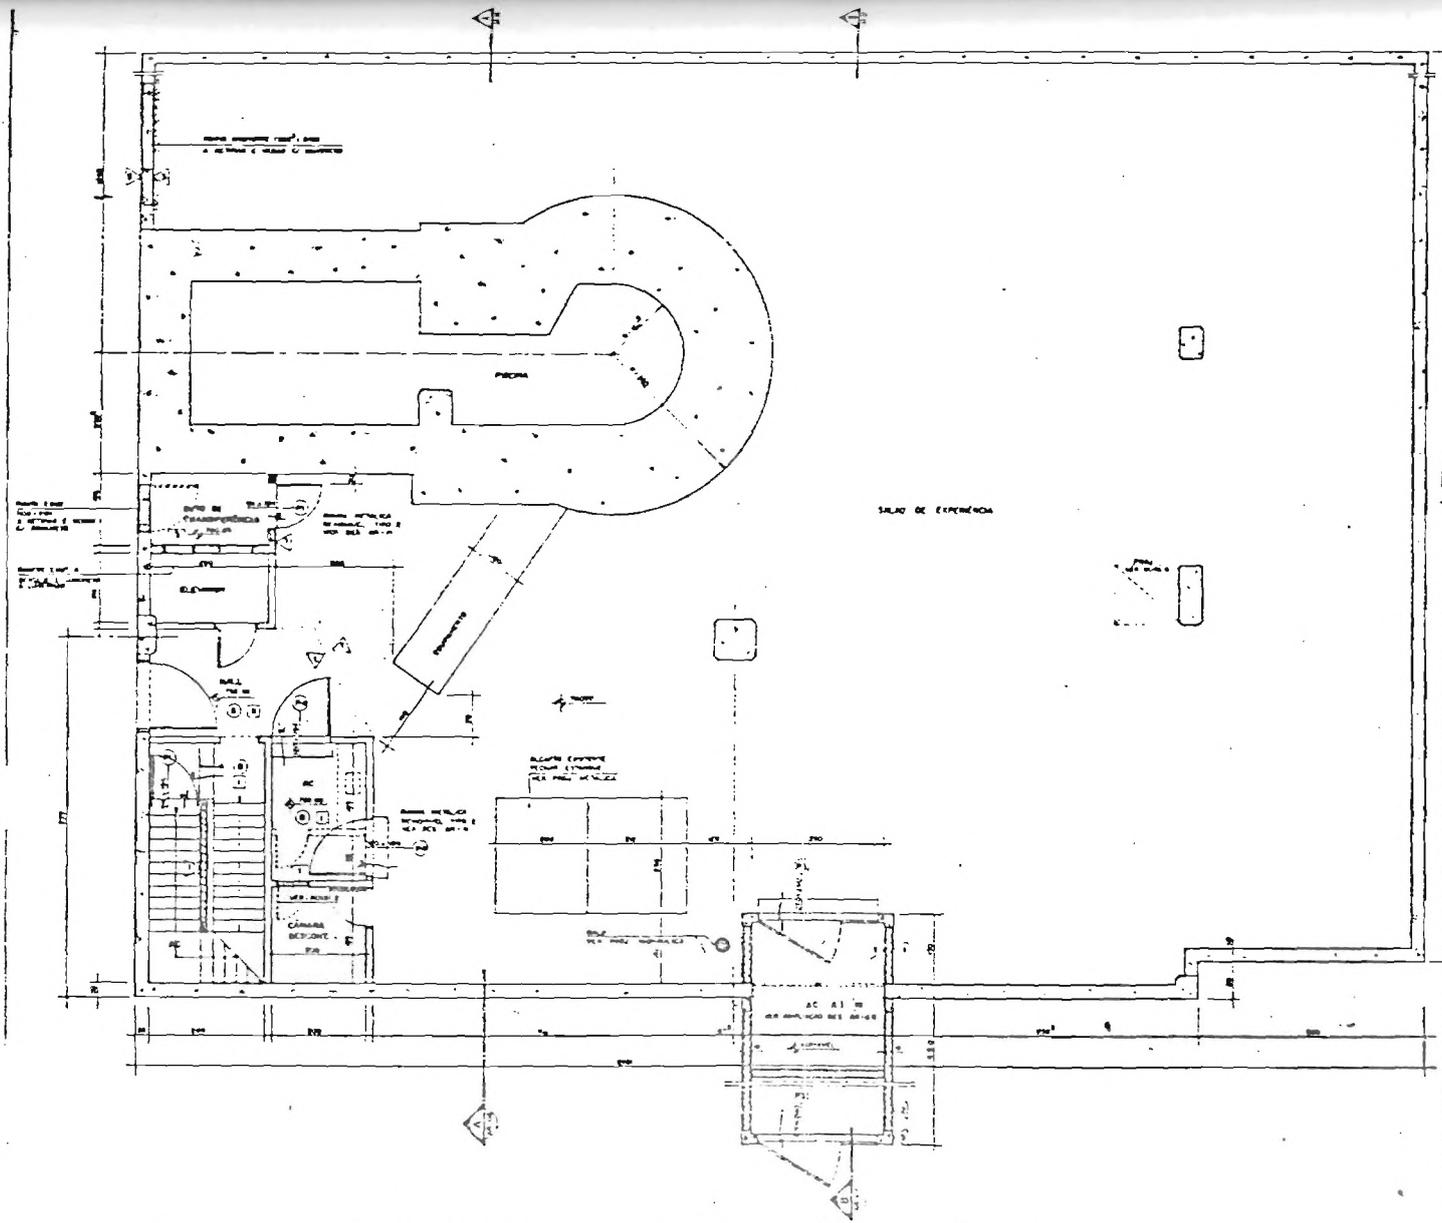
Planta do 19º pavimento mostrando as áreas quente e fria
